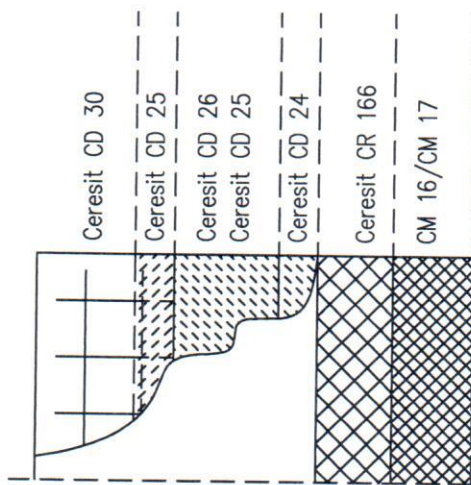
System PCC – naprawa konstrukcji żelbetowej: krawędź loggii
